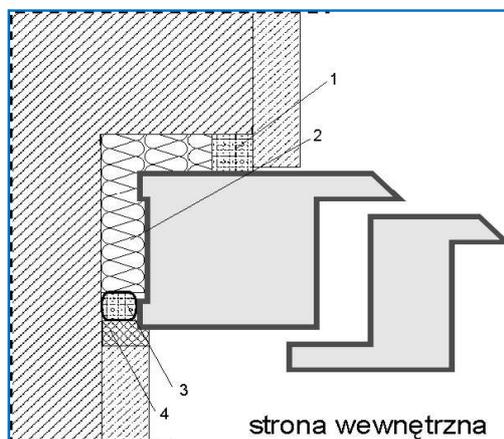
Guarnizione dello spazio tra la finestra e lo stipite nel muro pieno con mazzetta
